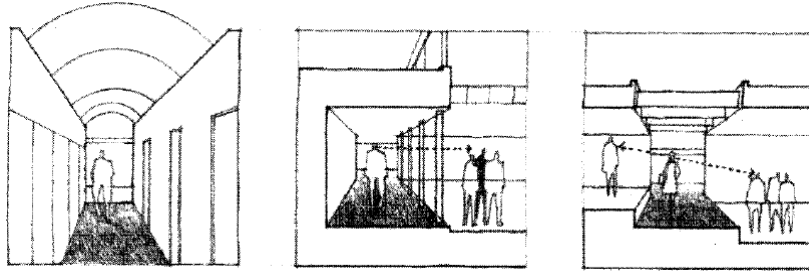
14 Hubungan Jalan Dengan Ruang
